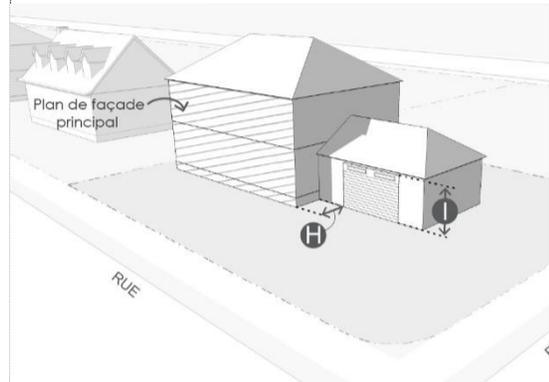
Retrait d'un garage par rapport à un plan de façade principal et hauteur d'une porte de garage
